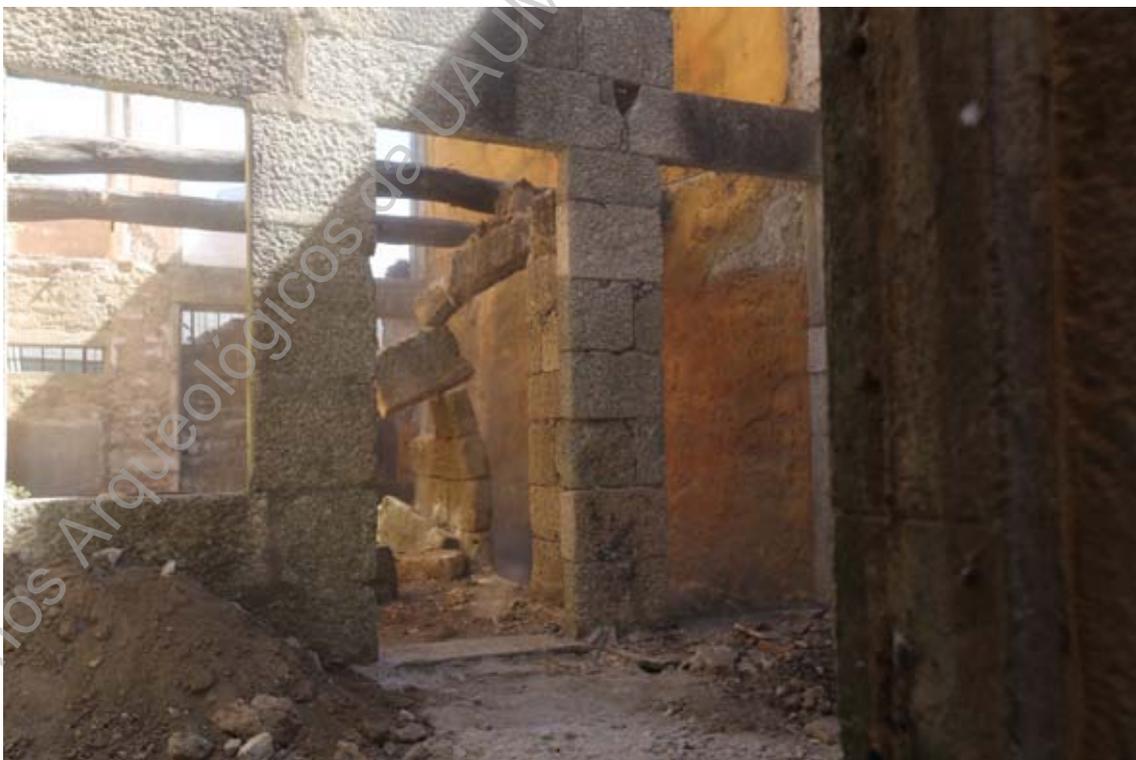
(IMG_0024) – Acompanhamento da demolição da parede interna UE014.
